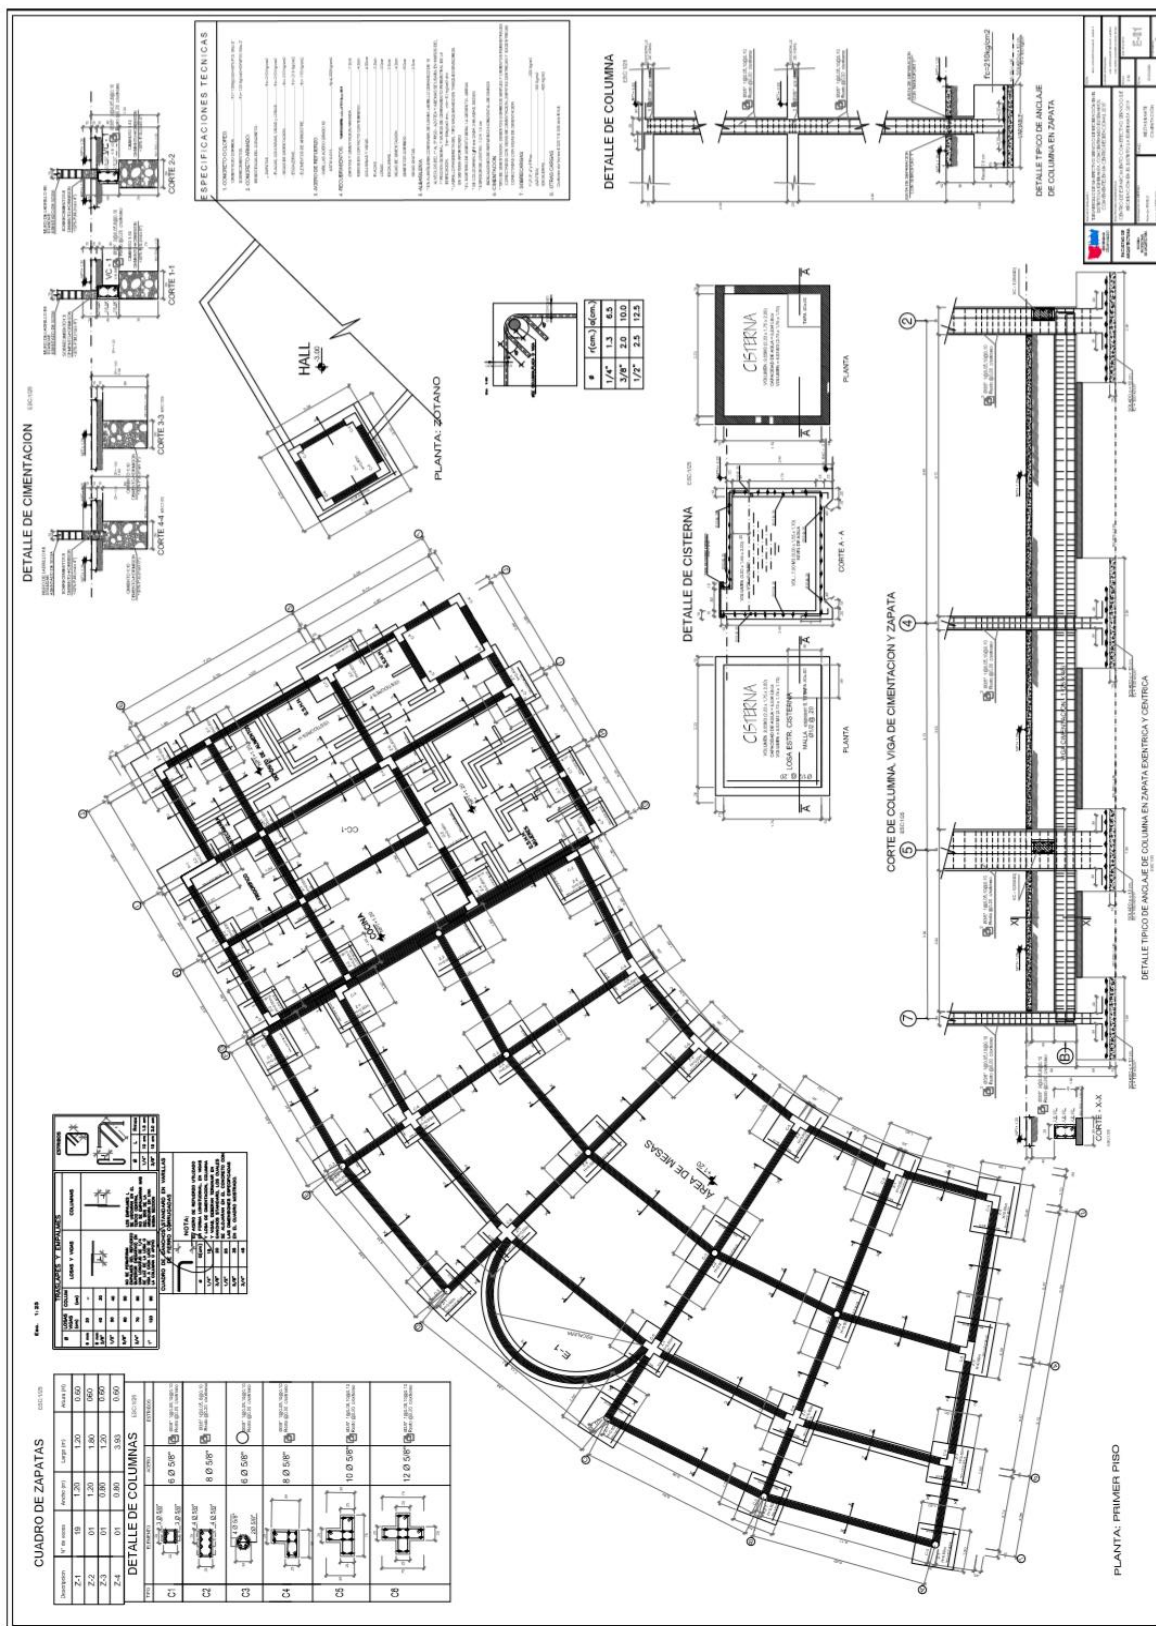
Plano de Restaurante - Cimentación. Elaboración propia.
